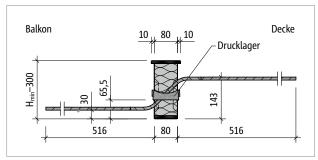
Schöck Isokorb® T Typ QL-V4: Produktschnitt
